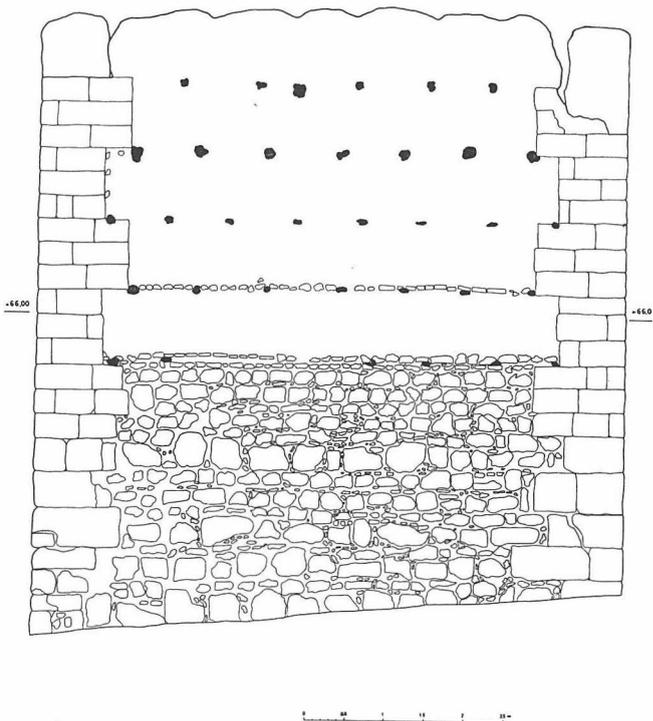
Torre A, alzado sur (corresponde al muro 8).
